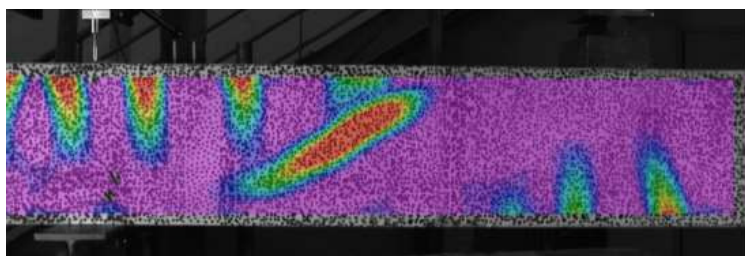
Exemple d'une fissure inclinée dans la poutre NS-15
